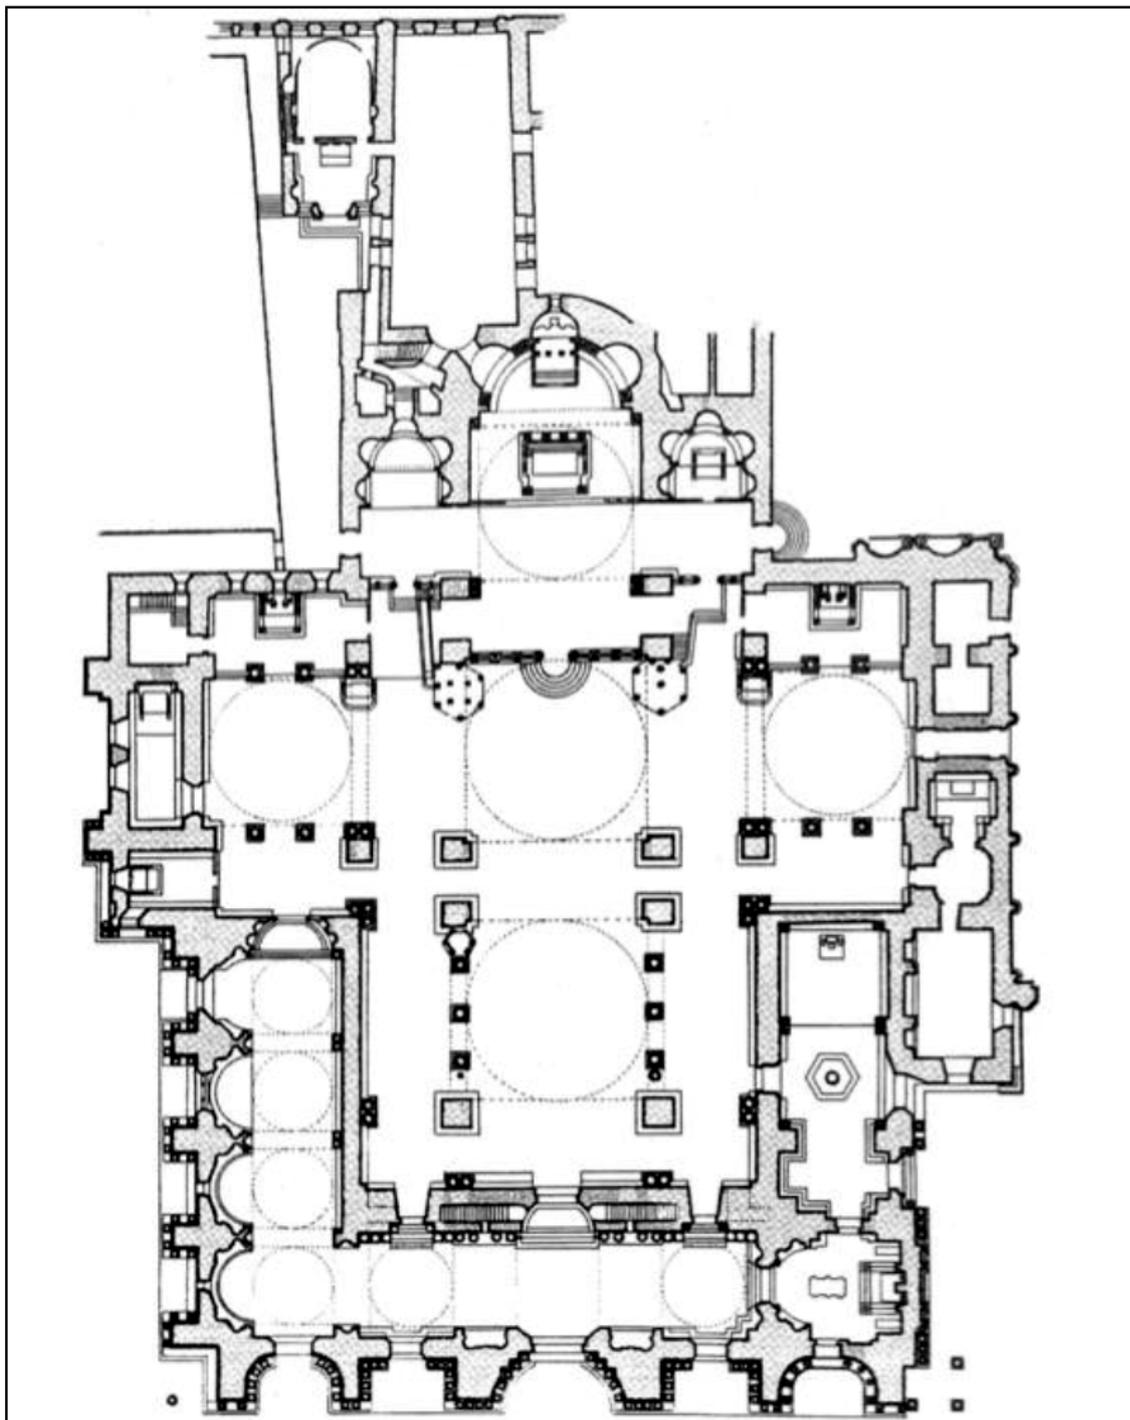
Planta da Basilica di San Marco. A face esquerda da imagem aponta para norte¹².
